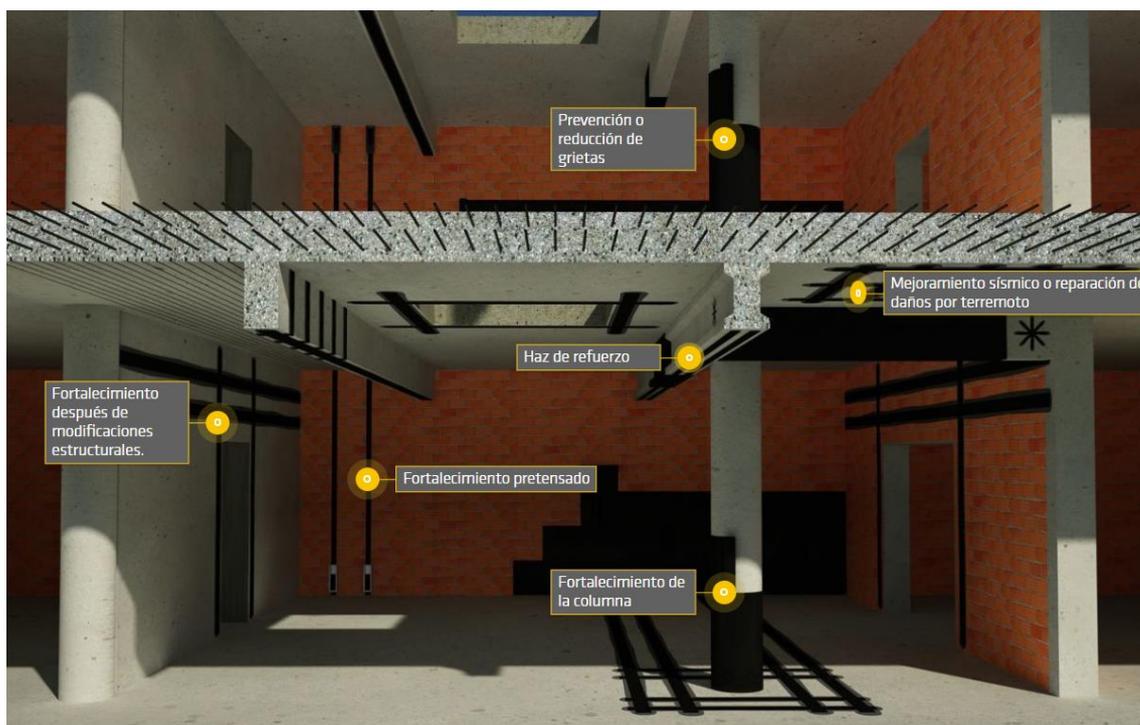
Sistema de reforzamiento estructural con fibra de carbono en elementos estructurales
